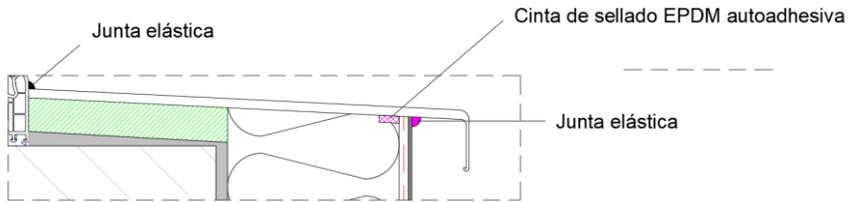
Detalle constructivo. Sistema SATE arranque de fachada. (Elaboración propia, 2023).
